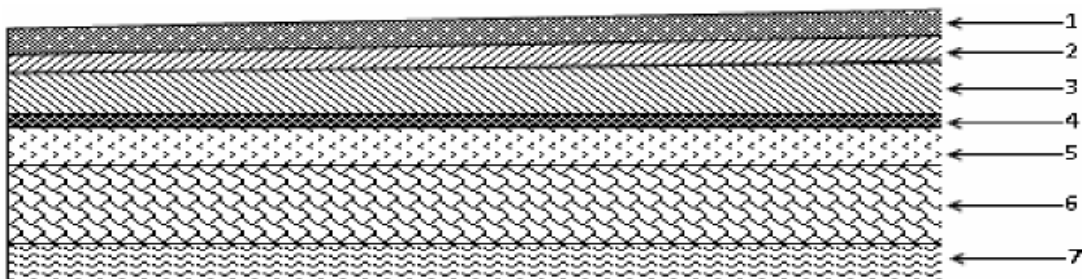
Coupe transversale du plancher terrasse inaccessible
